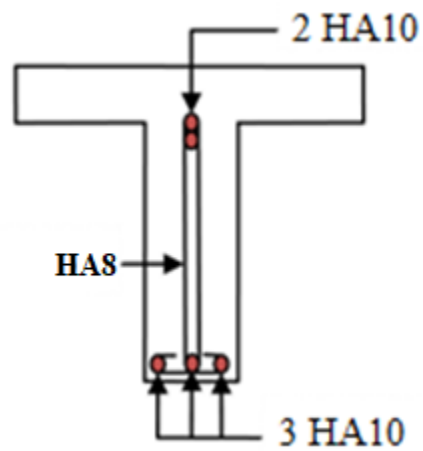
Ferrailage de la poutrelle sur appuis.
